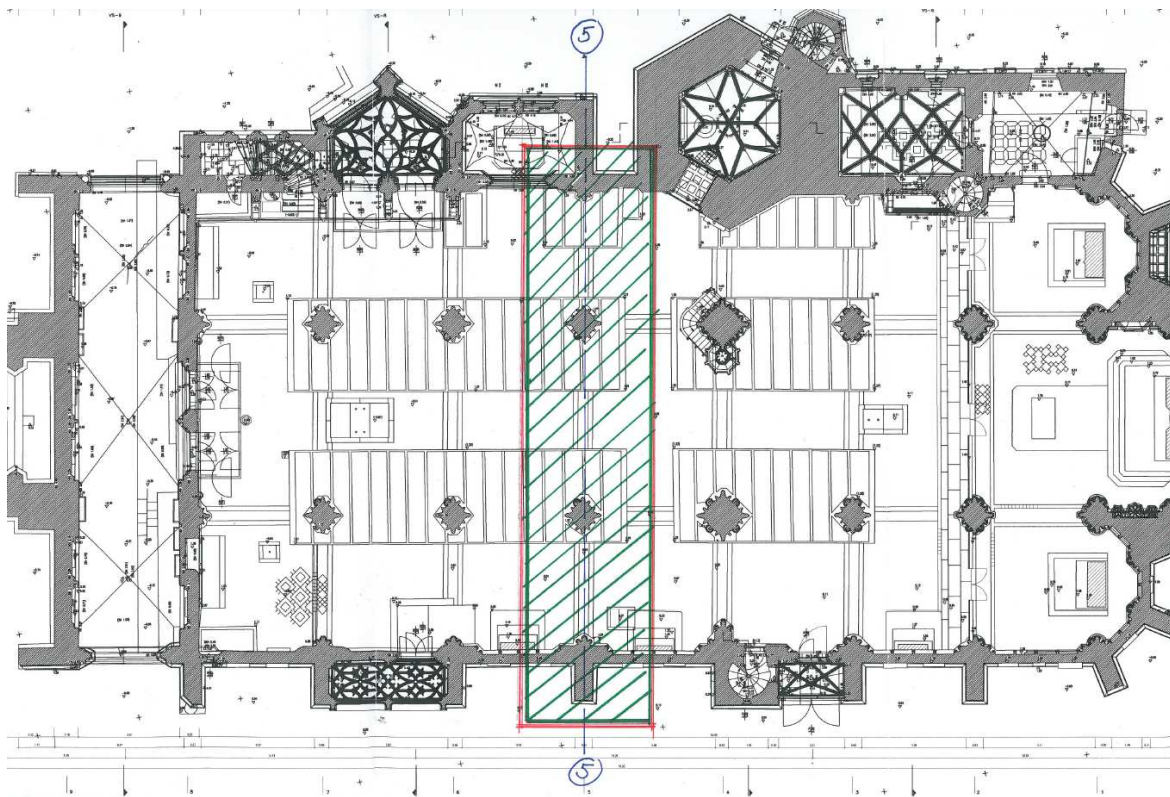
Steyr, Stadtpfarrkirche, Grundriss; Lasteinflussbereich der Pfeilerachse 5
